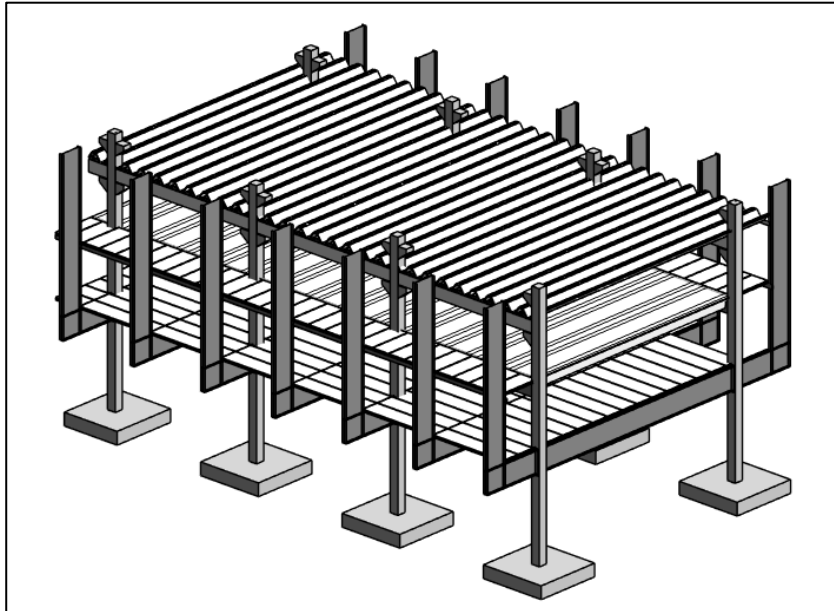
Colocación de los paneles Ypsilon de cubierta. Fuente: Autor.
